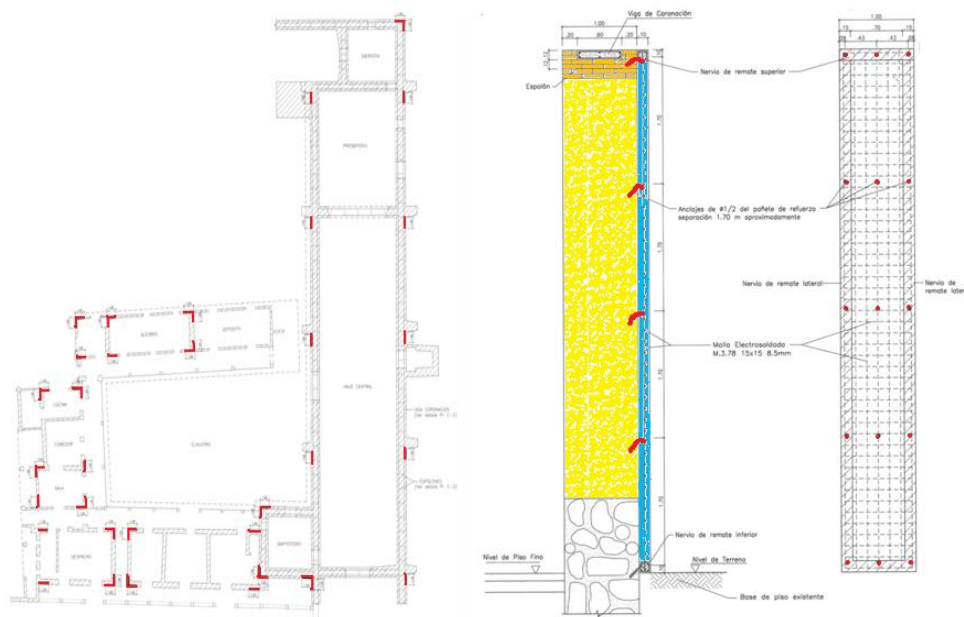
Localización y detalle de anclaje de pantallas de concreto, Templo doctrinero de Oicatá – Boyacá. Fuente: Proyecto de intervención estructural: Arq.-Ing. José Gustavo Martínez (Detalle y planos originales retocados con color)
